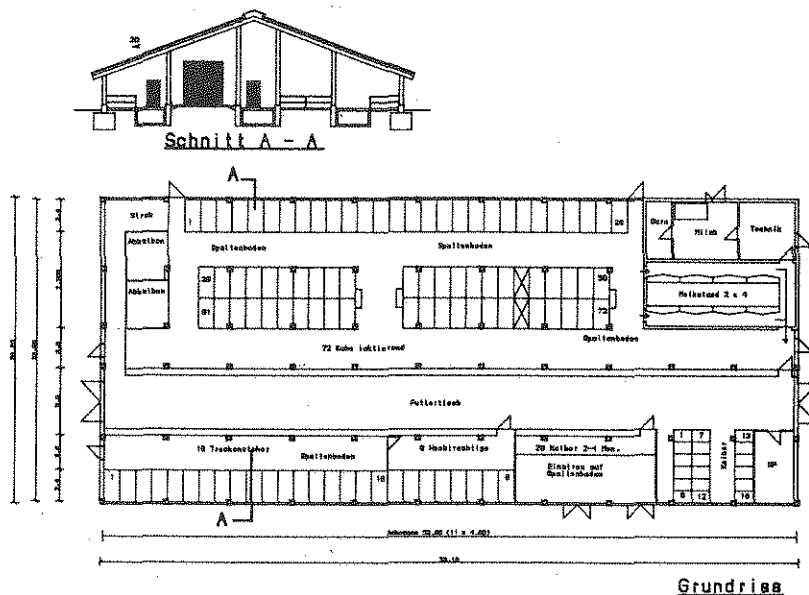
Modellplan für 90 Kühe (Kaltstall in Rundholzkonstruktion)
